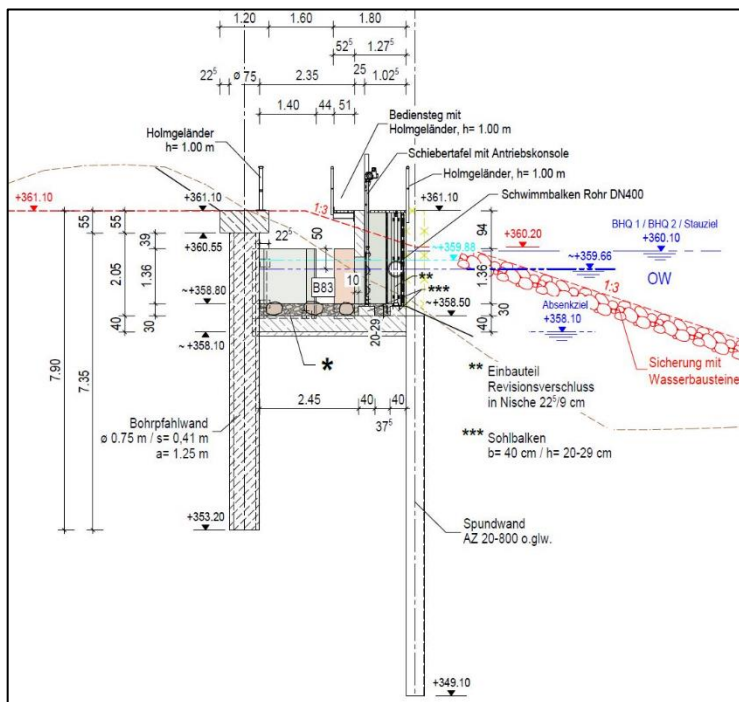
Schnitt 3-3 Ausstiegsbauwerk – Schlitzpass mit Galerie
